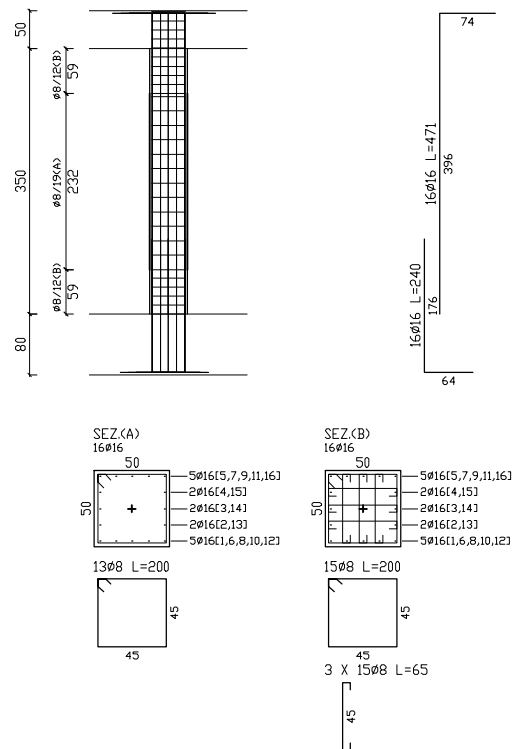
Carpenteria pilastri-Edificio a pannelli
